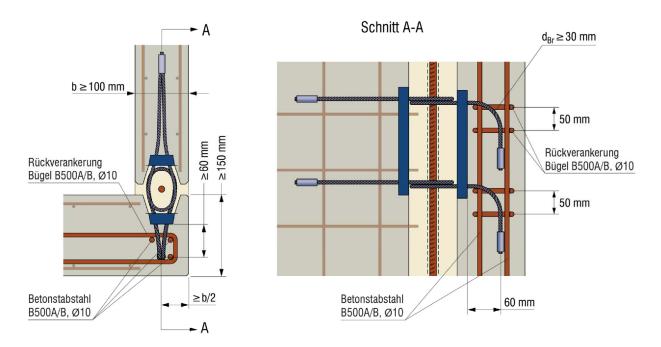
Wand – Wand – Eckverbindung - Detail mit abgewinkelten Seilschlaufen
